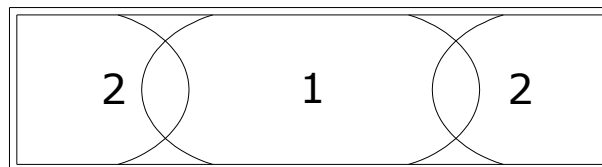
Secuencia de llenado del molde (UNE-EN 14651:2007 + A1:2008).
